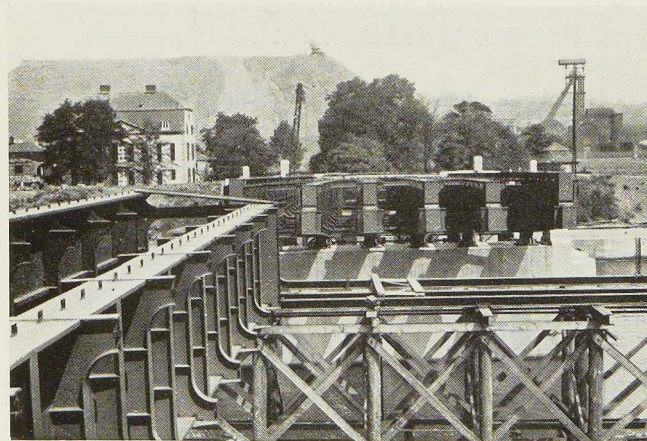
Montage du pont. On voit l'extrémité des bras cantilever de la travée centrale.
